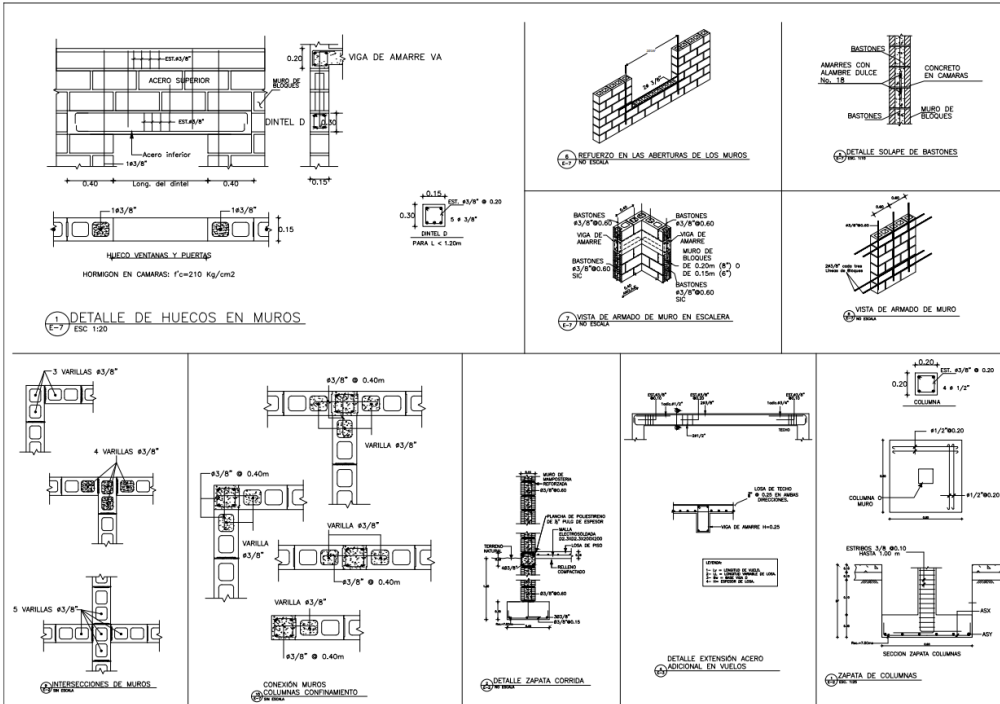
Detalles constructivos de las casetas de manifold. Estos detalles fueron elaborados por TNR usando el software AutoCAD.
